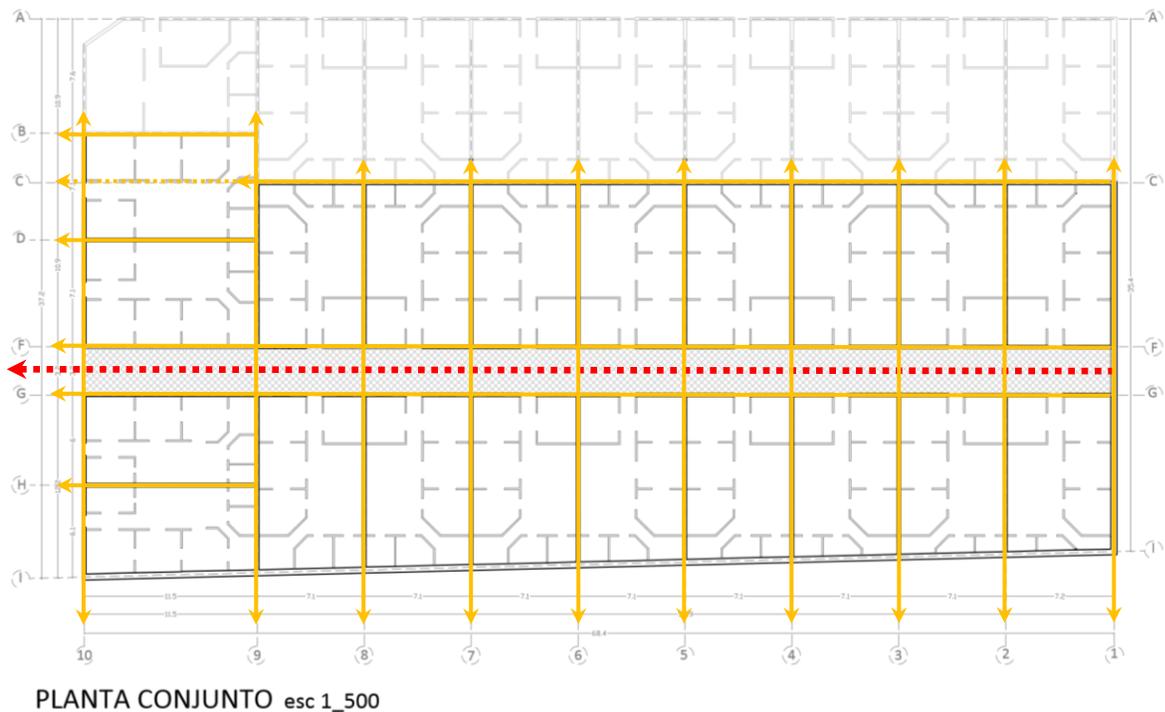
Planta conjunto intervenida, se muestra en naranja los ejes verticales y perpendiculares todos continuos.
